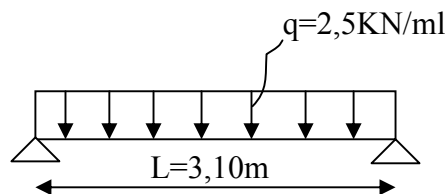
Schéma statique de calcul de la poutrelle
